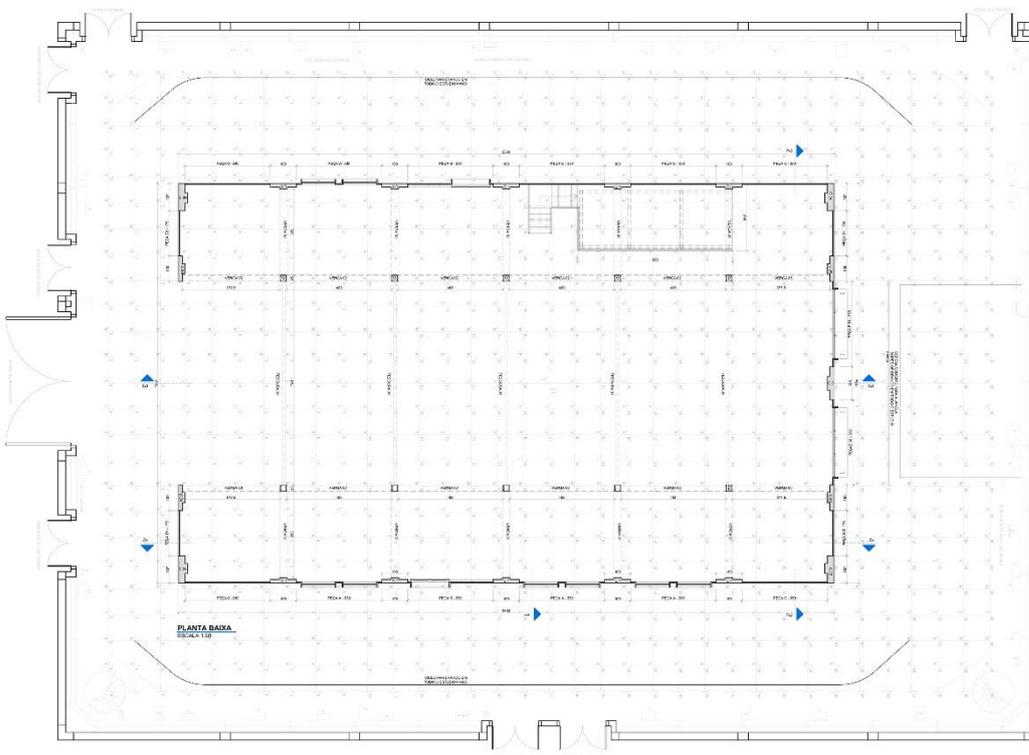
Desenho técnico – planta baixa do cenário posicionado dentro do estúdio.
